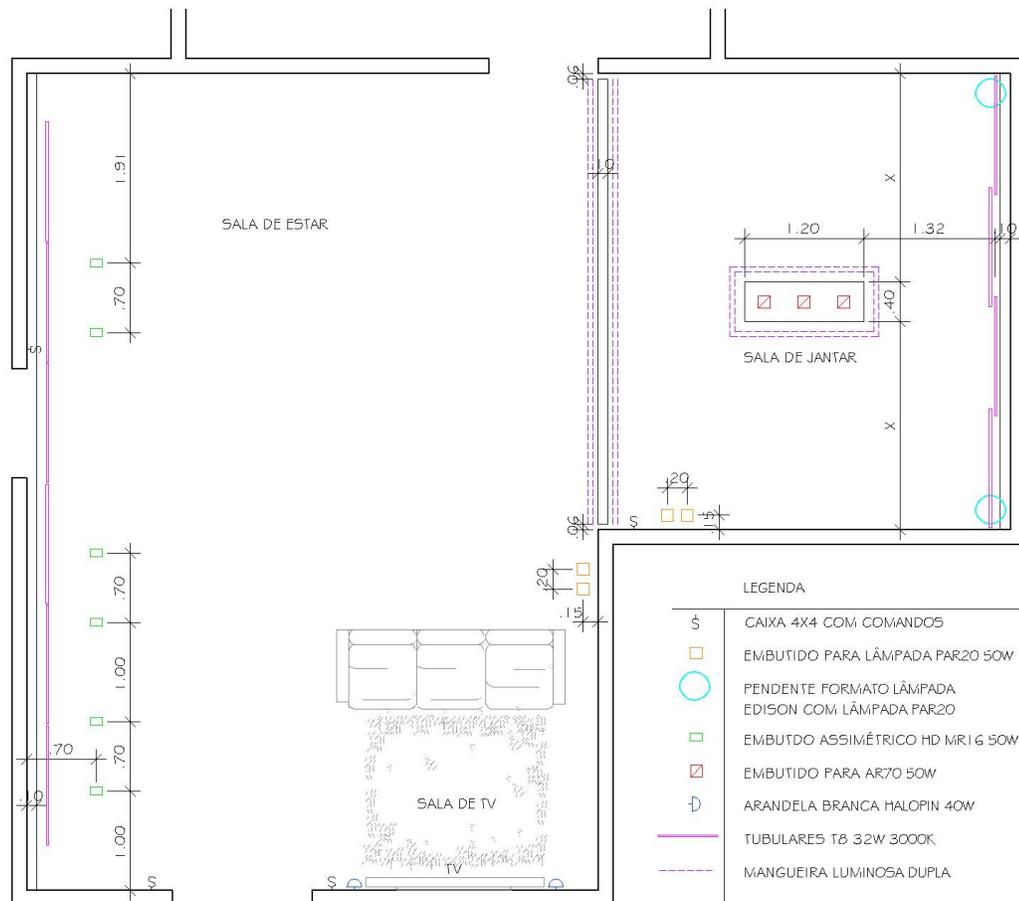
Planta baixa das salas de estar, jantar e TV do apartamento.
